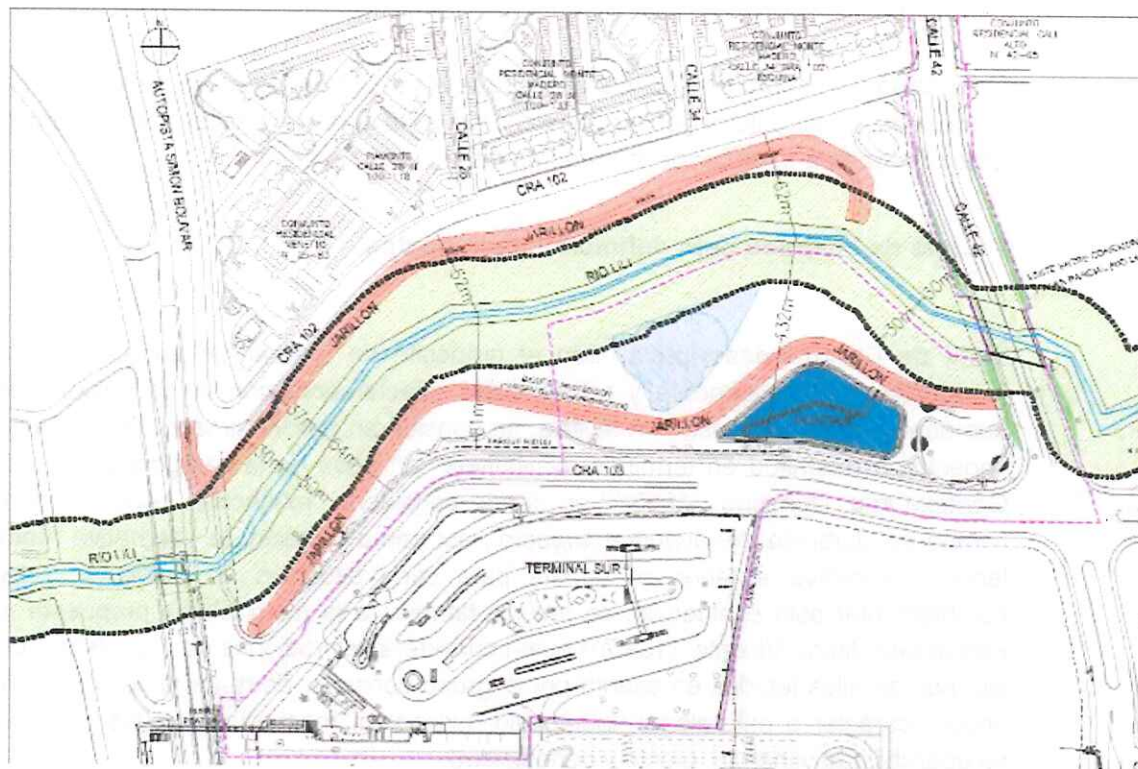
Vista en planta del proyecto de la terminal y ubicación del Pondaje. Fuente: Metro Cali (2018)
